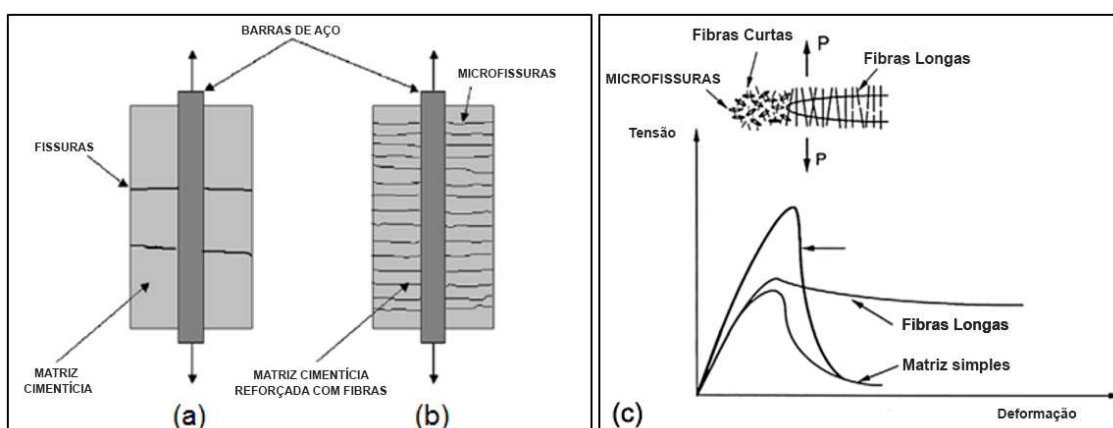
Fissuras em tirantes submetidos à tração: (a) para o concreto convencional, (b) concreto com adição de fibras, (c) controle da propagação de fissuras para fibras longas e curtas.
